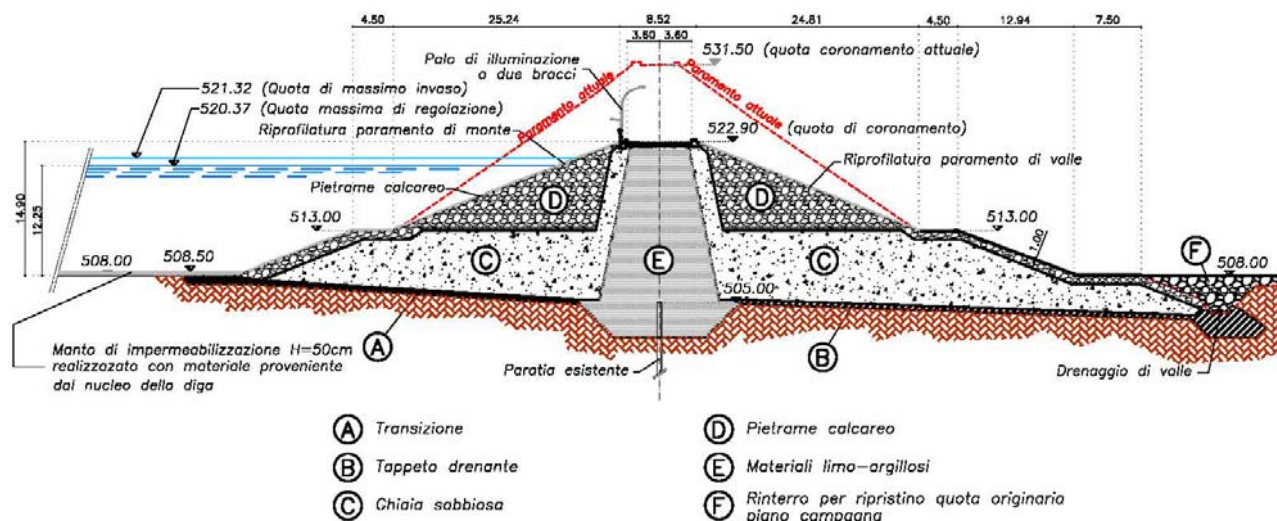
Sezione trasversale del corpo diga con evidenziazione dell'abbassamento in progetto
